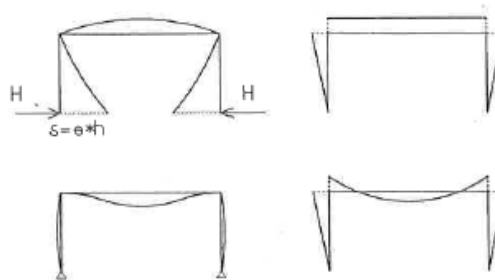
Comportamiento biempotrado cuando el suelo impide el desplazamiento horizontal de las pilas en la unión con este. (“Puentes: Apuntes para su diseño, cálculo y construcción” por Javier Manterola Armisen, Cap.9)
